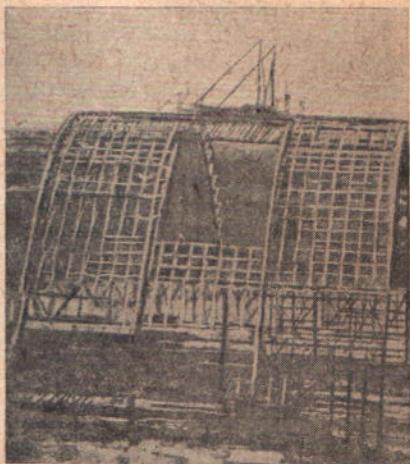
Установка на коньке арок крана для монтажа прогонов
